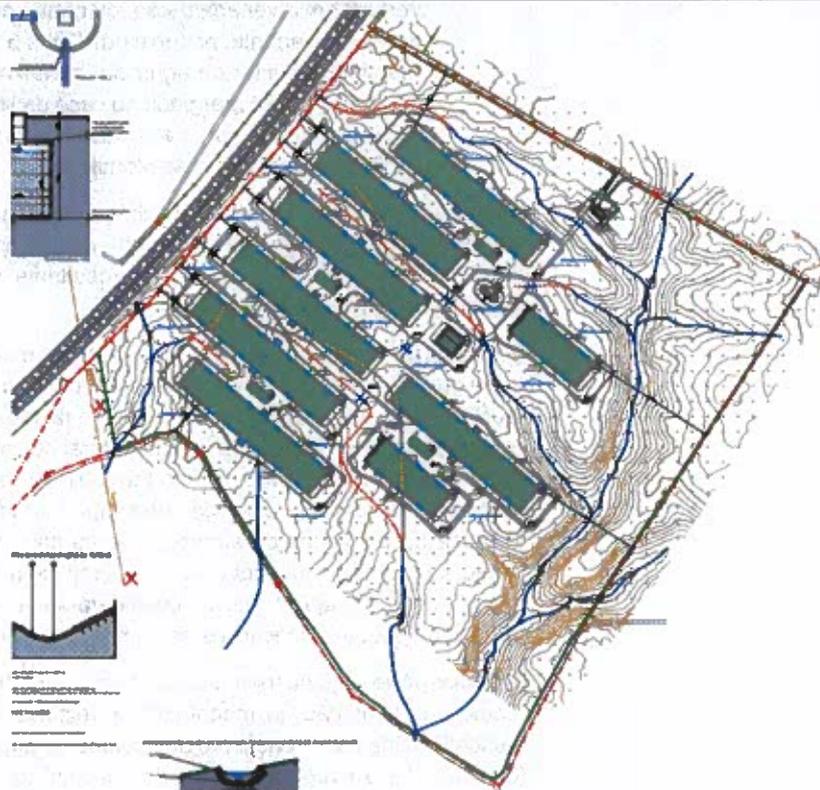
Extrato da Planta de Implantação - Águas Pluviais (Fonte: Anexo EIA, Peça n.º 11.4 - vs. 02)
